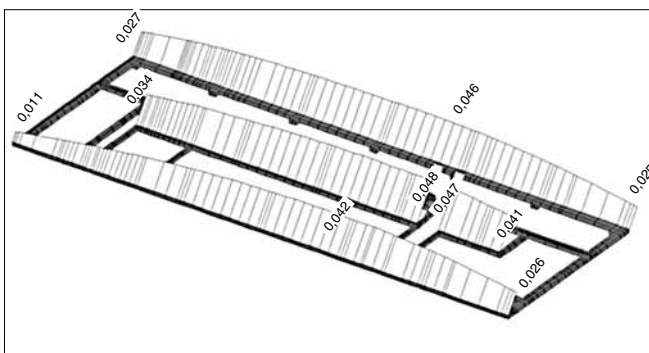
Эпюры подъемов фундаментов здания без учета жесткости надземных конструкций
